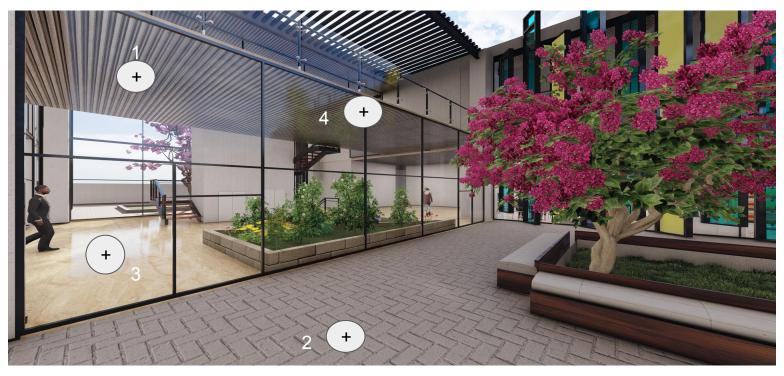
Elaboración de Arguello B. (2022). Planta Baja. Patios exteriores.
